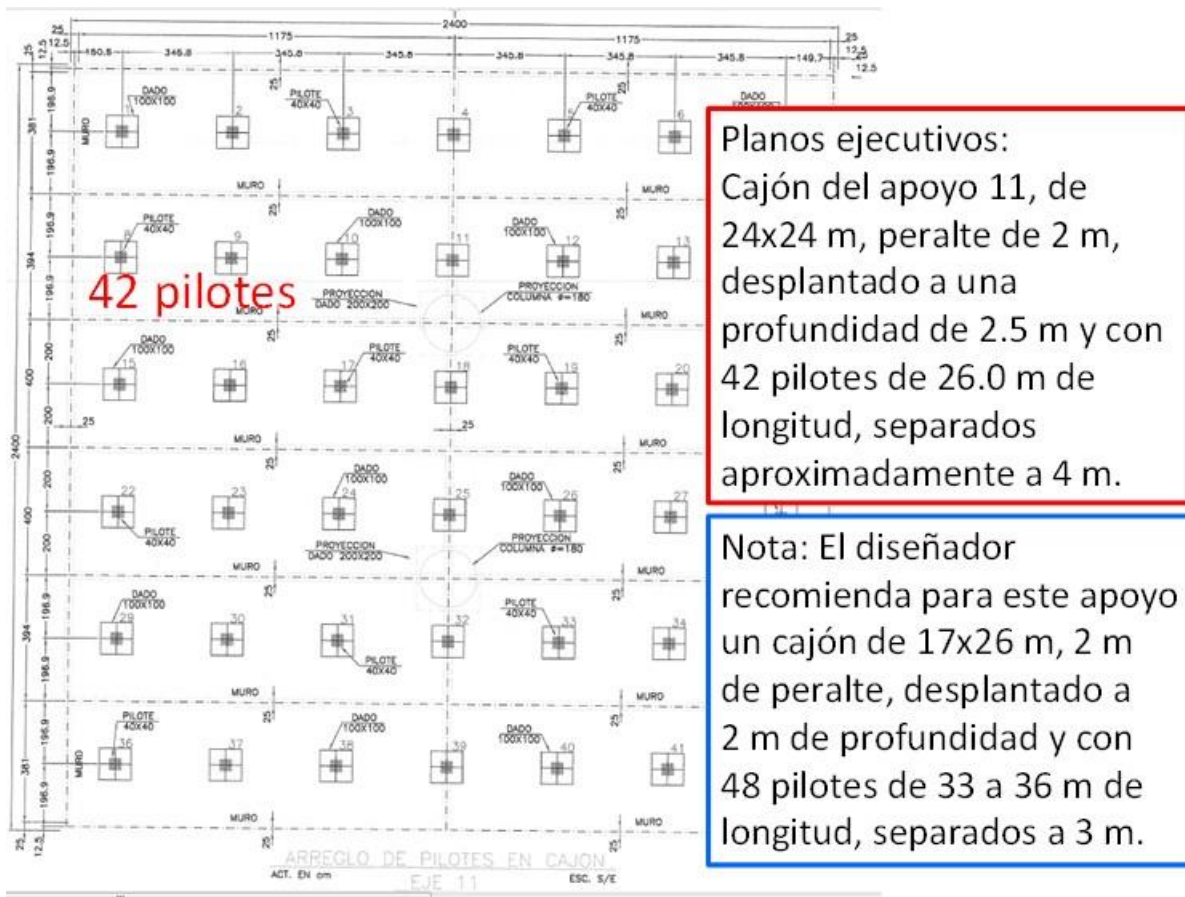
Vista en planta del apoyo 11 con las características de planos ejecutivos y lo establecido por el diseñador
